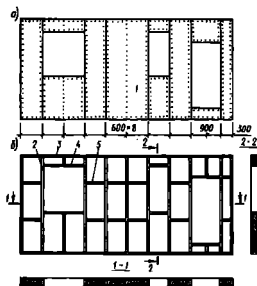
Клефанерная укрупненная панель наружной стены:
